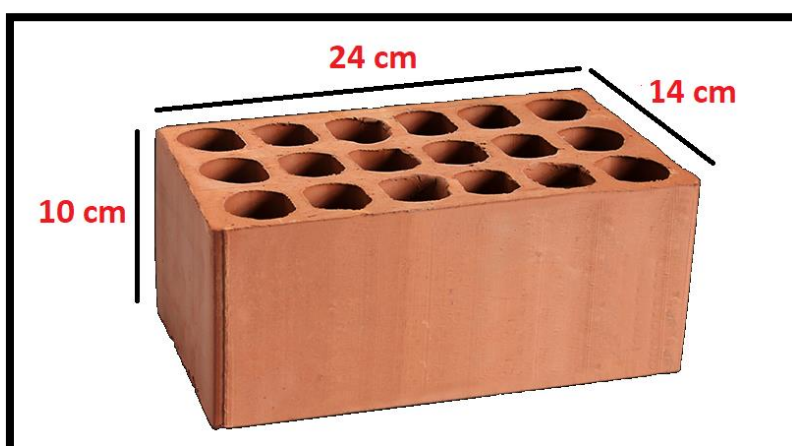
Dimensiones de ladrillo mecanizado CCATEC
